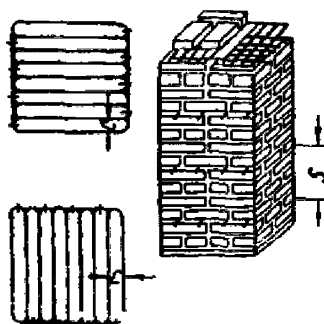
Армирование кирпичных столбов сетками «Зигзаг»
